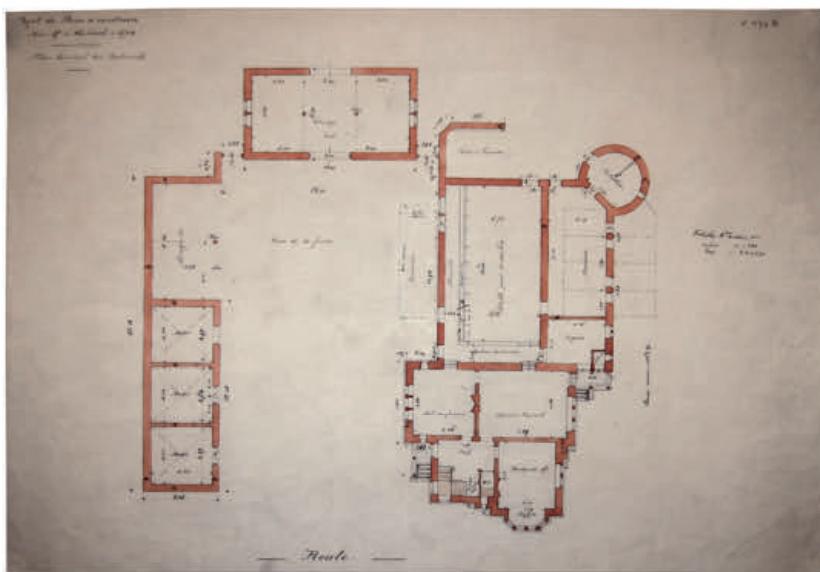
Spa, villa « Les Sorbiers ». Plan du rez-de-chaussée. A. Vivroux.
